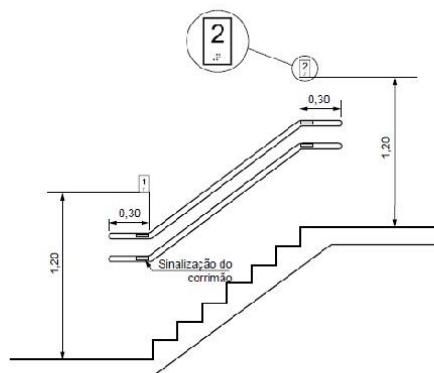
Sinalização de pavimento - Vista lateral (cotas em metros)
